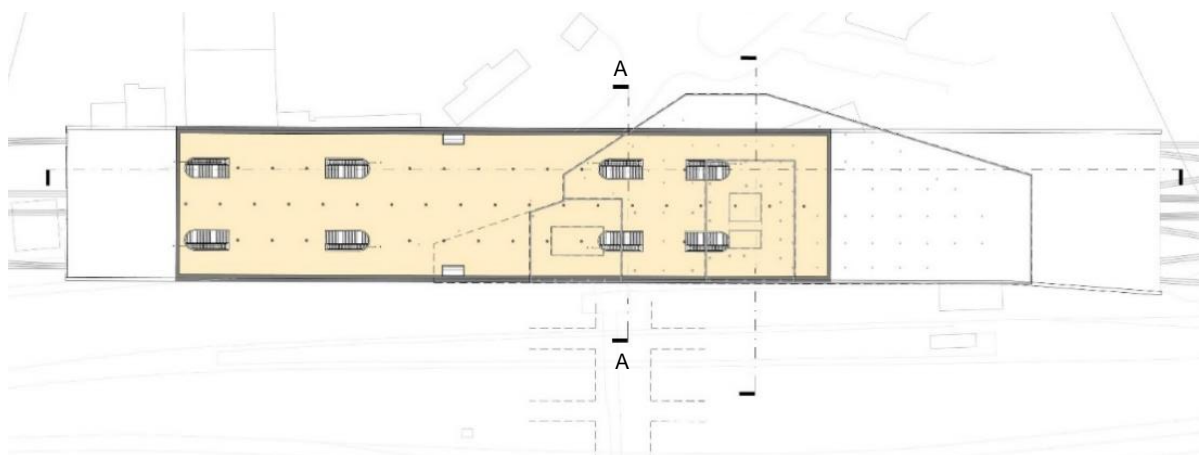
HP Altona Diebsteich IIIa - Grundriss Verteilerebene E-1
